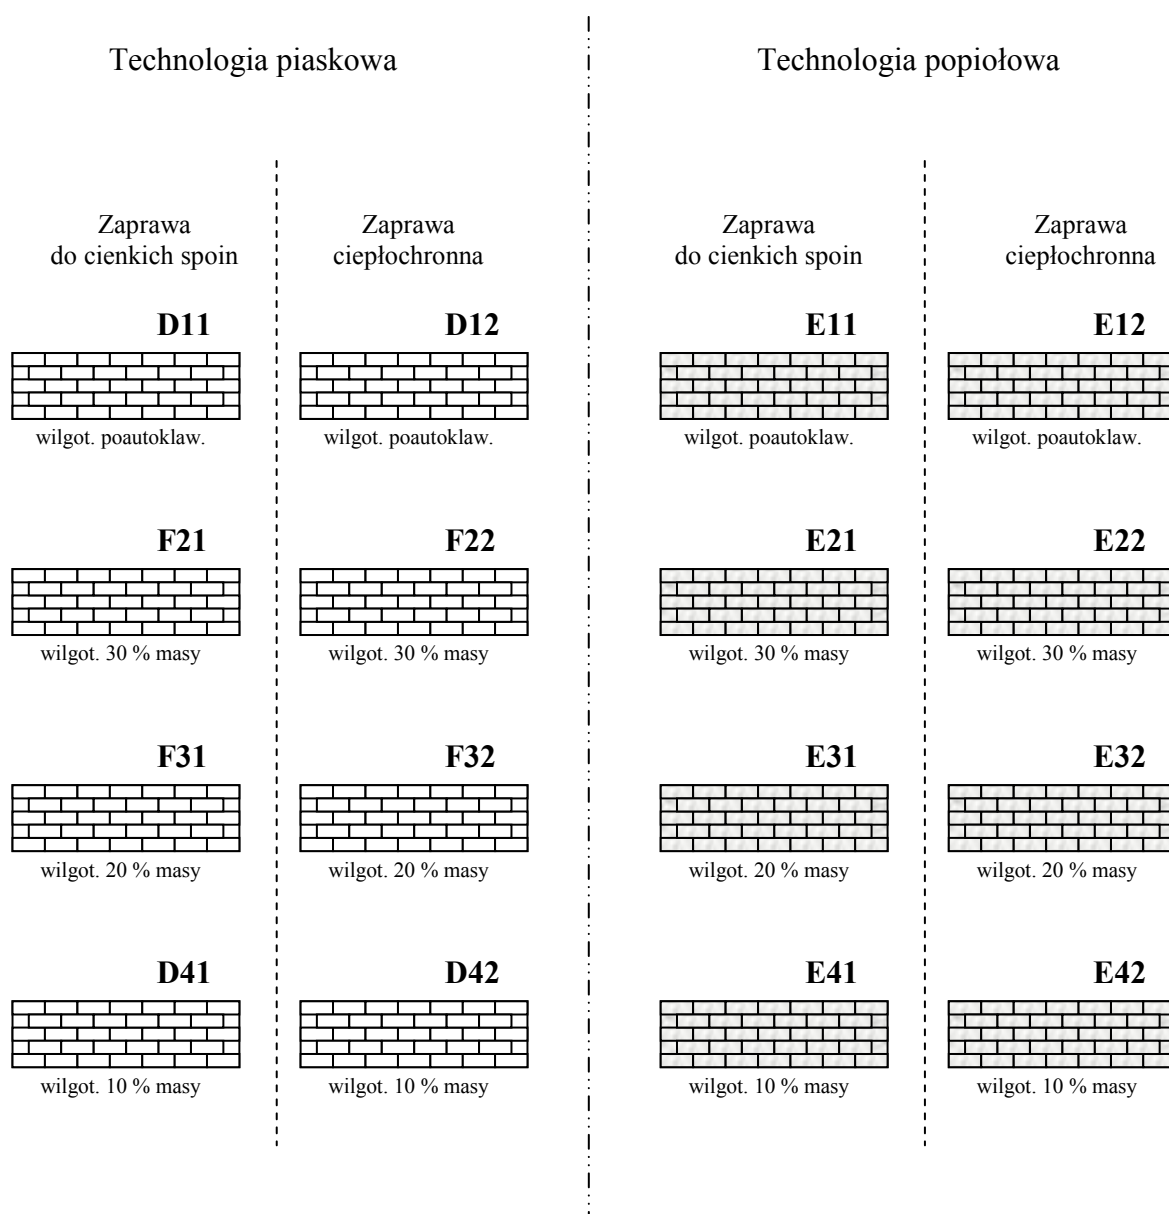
Suszenie (sezonowanie) elementów murowych z betonu komórkowego przed wmurowaniem
